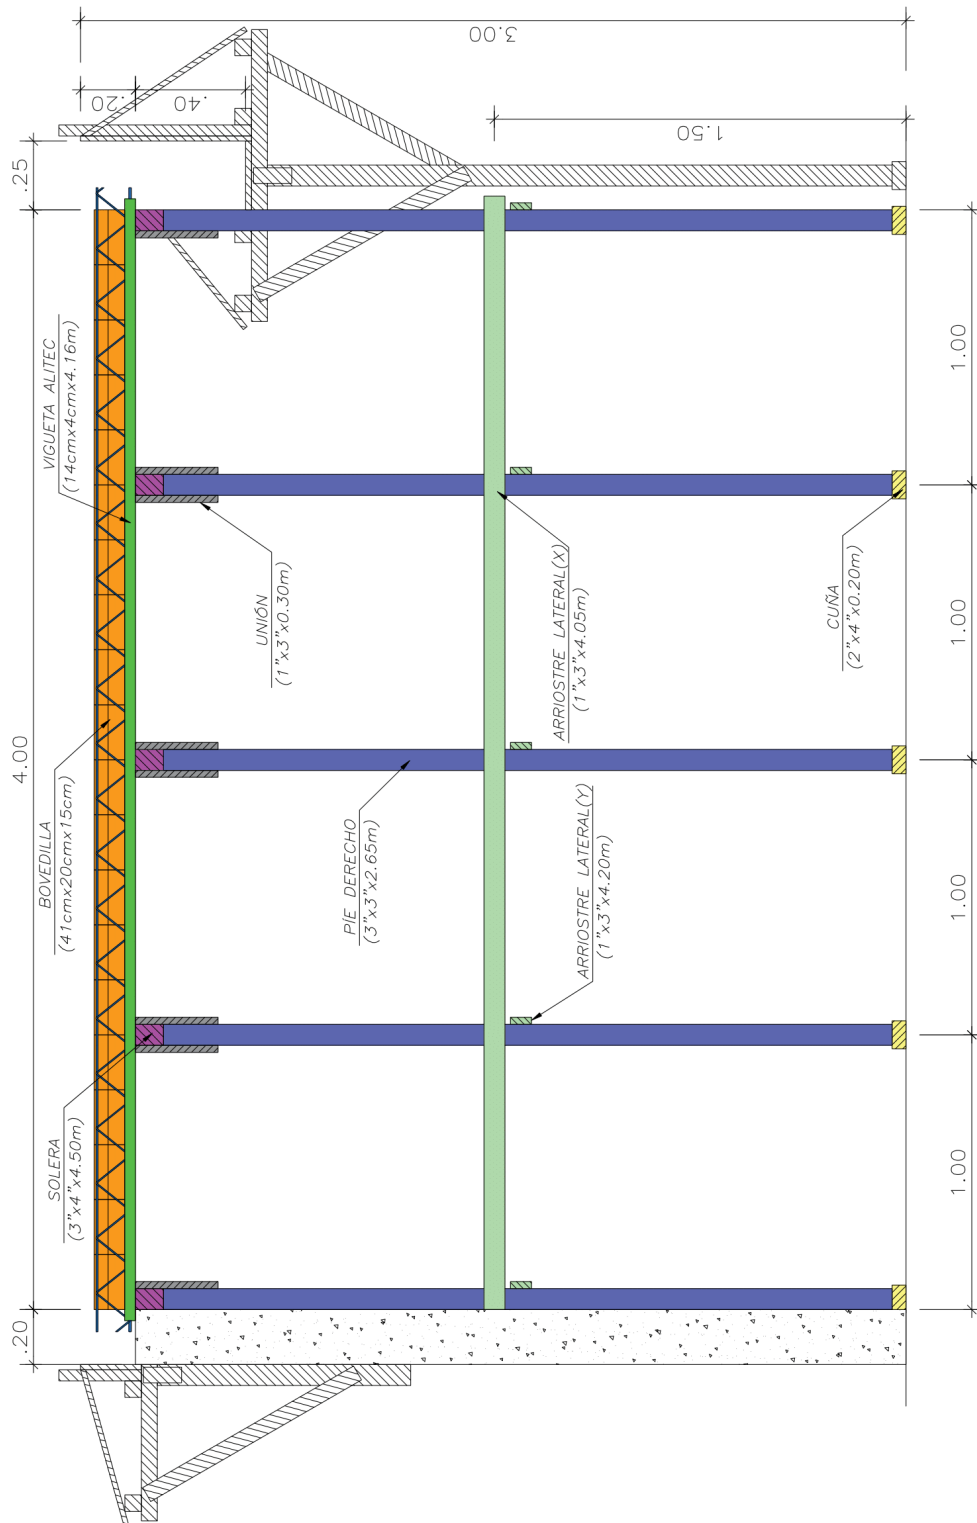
Corte Longitudinal A – A, para la Losa Aligerada Unidireccional Prefabricada Alitec.
